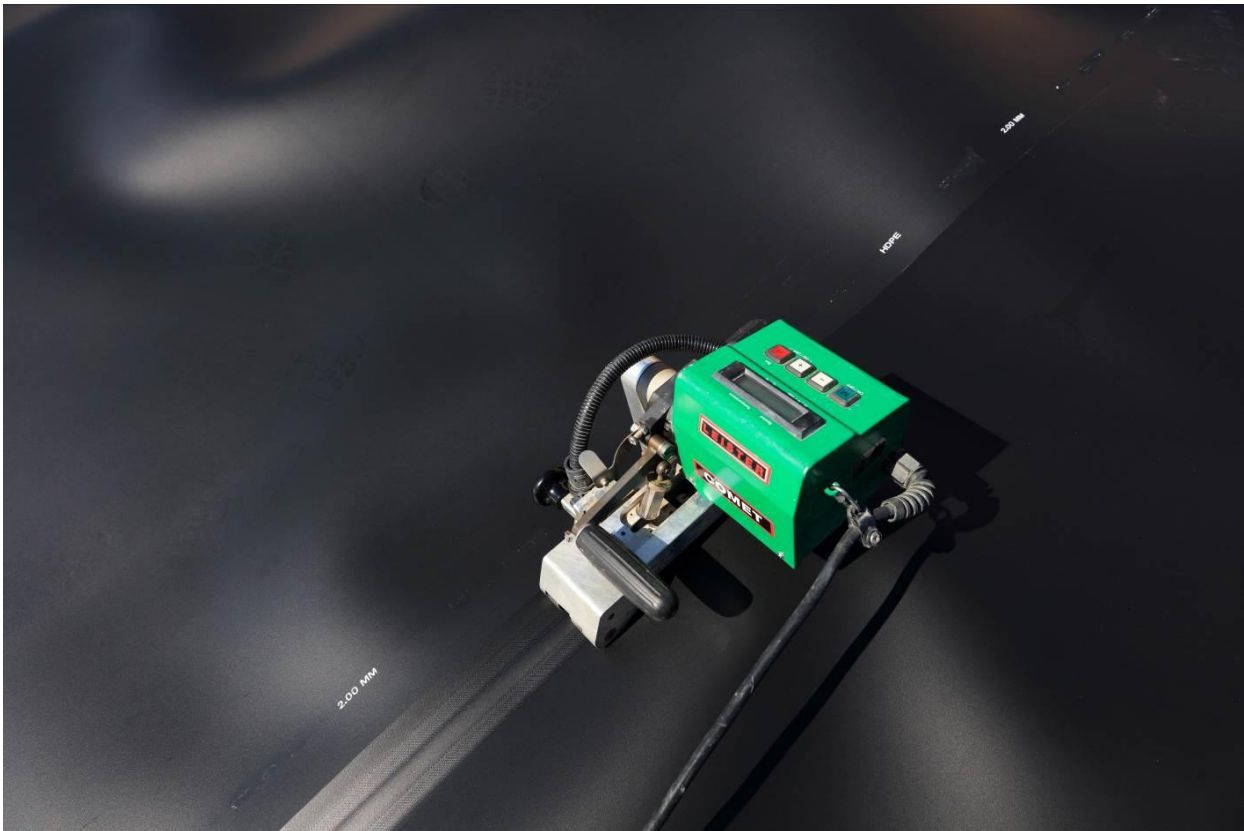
Exemple de double soudure automatique sur géomembrane PEHD.
